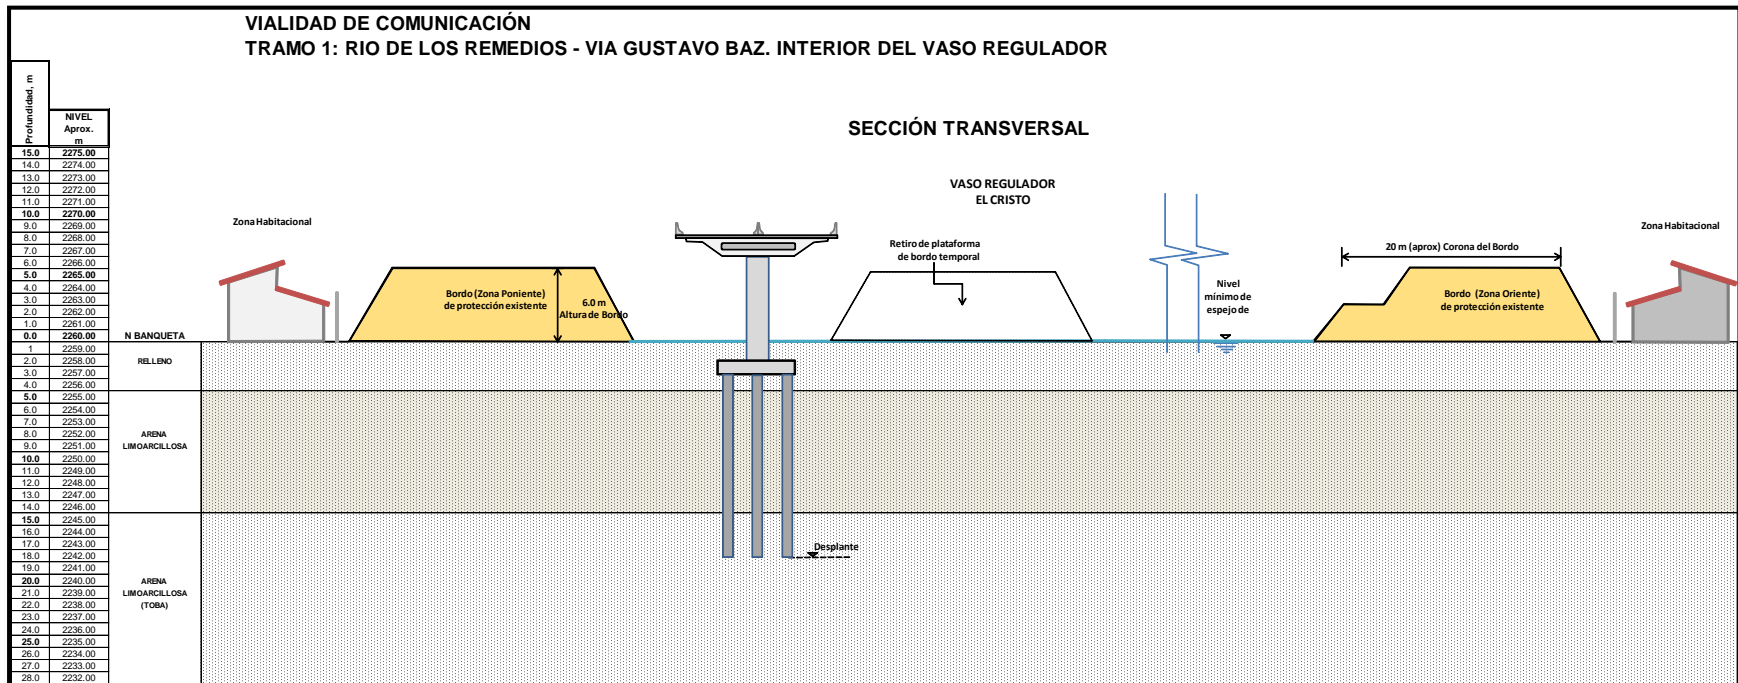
En esta figura se observa que una vez concluidos los trabajos de colocación de traveses y columnas así como la losa, parapetos y carpeta asfáltica donde circularán los vehículos, se procede con el retiro del bordo temporal de protección así como el relleno que se utilizó para apoyar este bordo de protección y dejar el interior del vaso en las condiciones iniciales previas a los trabajos realizados.
